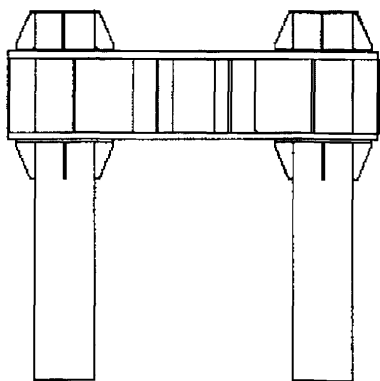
Схема четырёхсвайного фундамента, вид спереди (главный).
